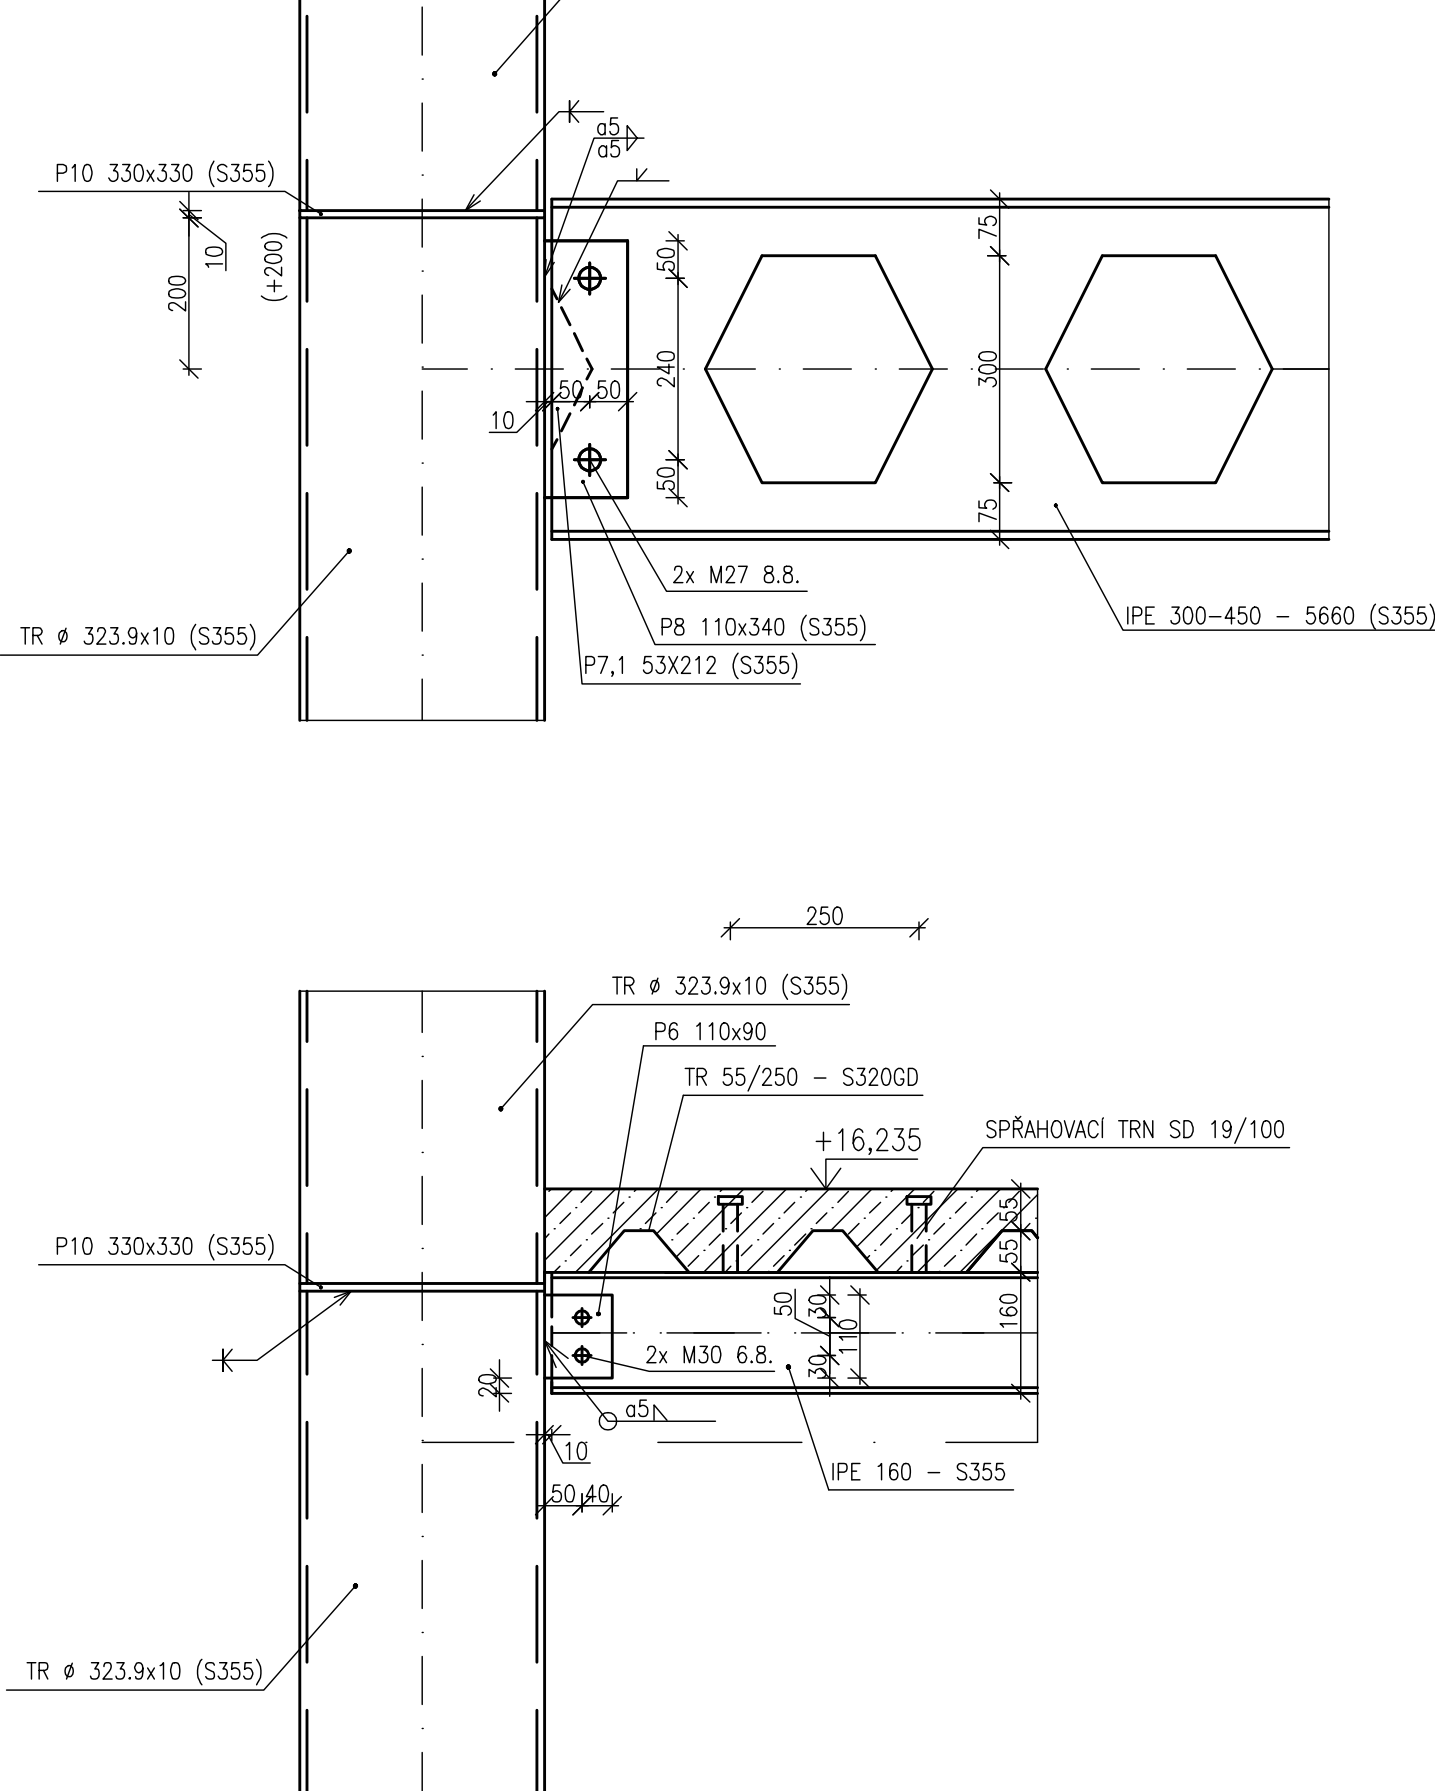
DETAIL PŘÍPOJ VAZNICE IPE 160 NA PŘÍČEL
